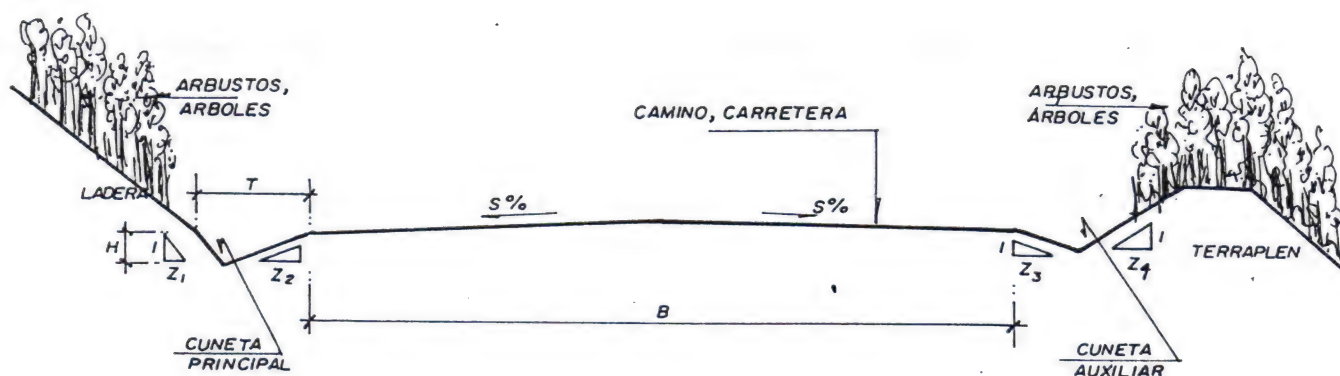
SECCION DE UNA CARRETERA CON DRENAJE APROPIADO
